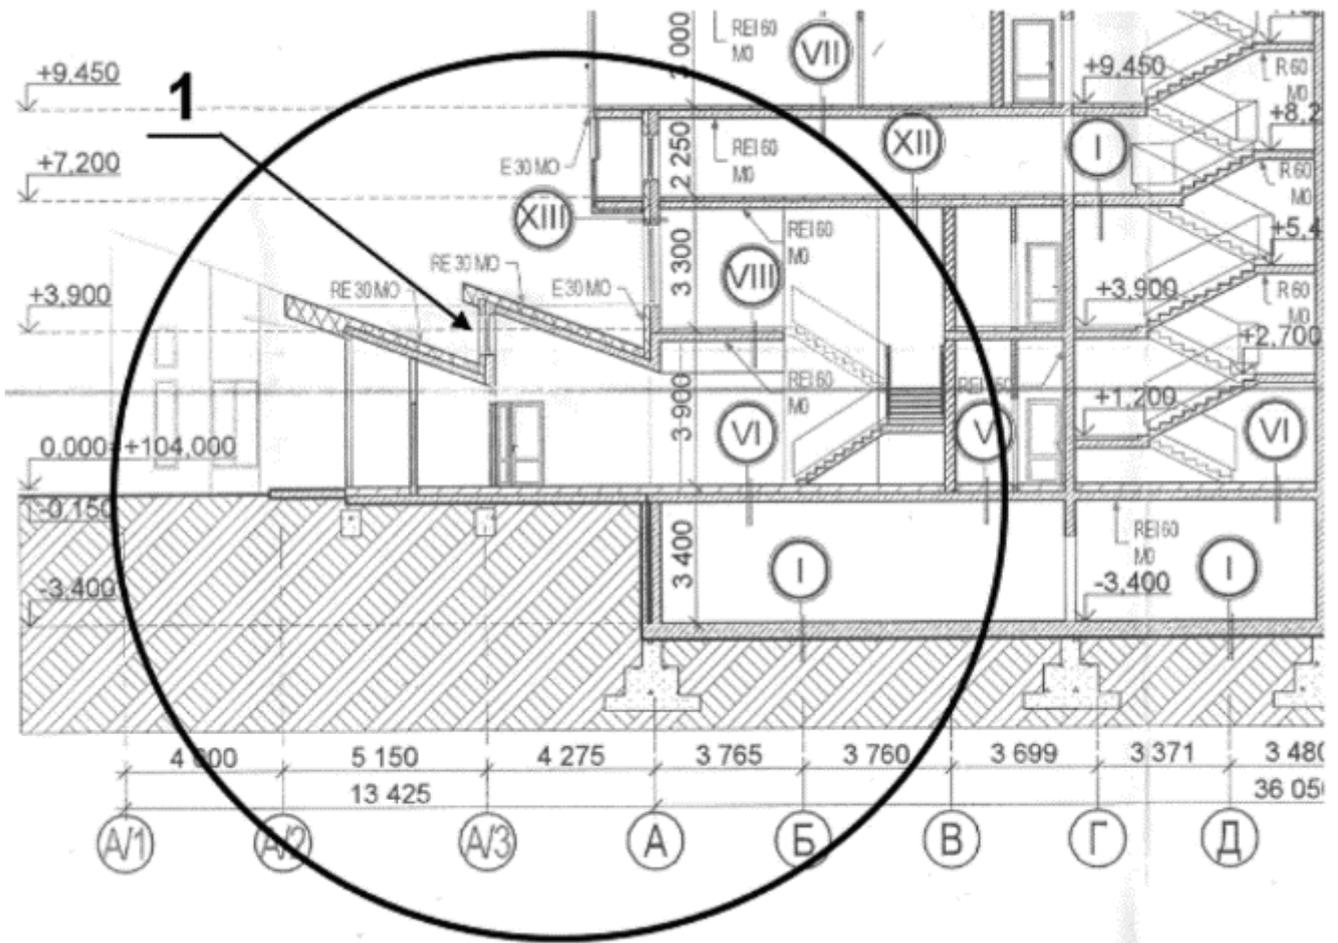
Розріз житлового будинку з будовано-прибудованими приміщеннями з північно-східного фасаду
